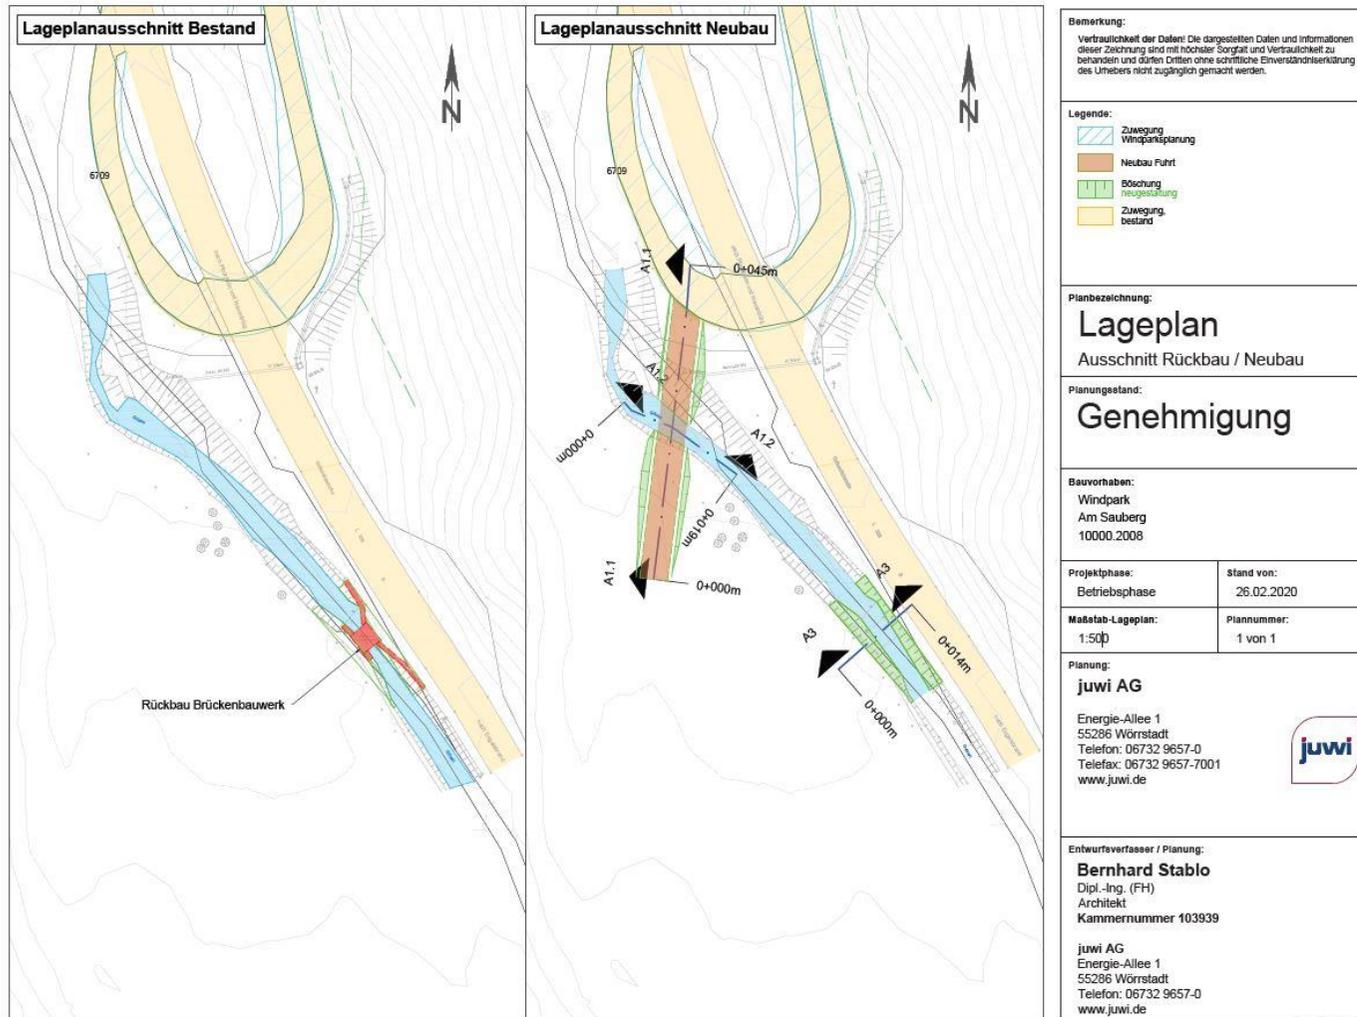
Detaillierter Lageplan für die geplante Gewässerrenaturierung (Rückbau) am Grösselbach (Maßnahme M5).
